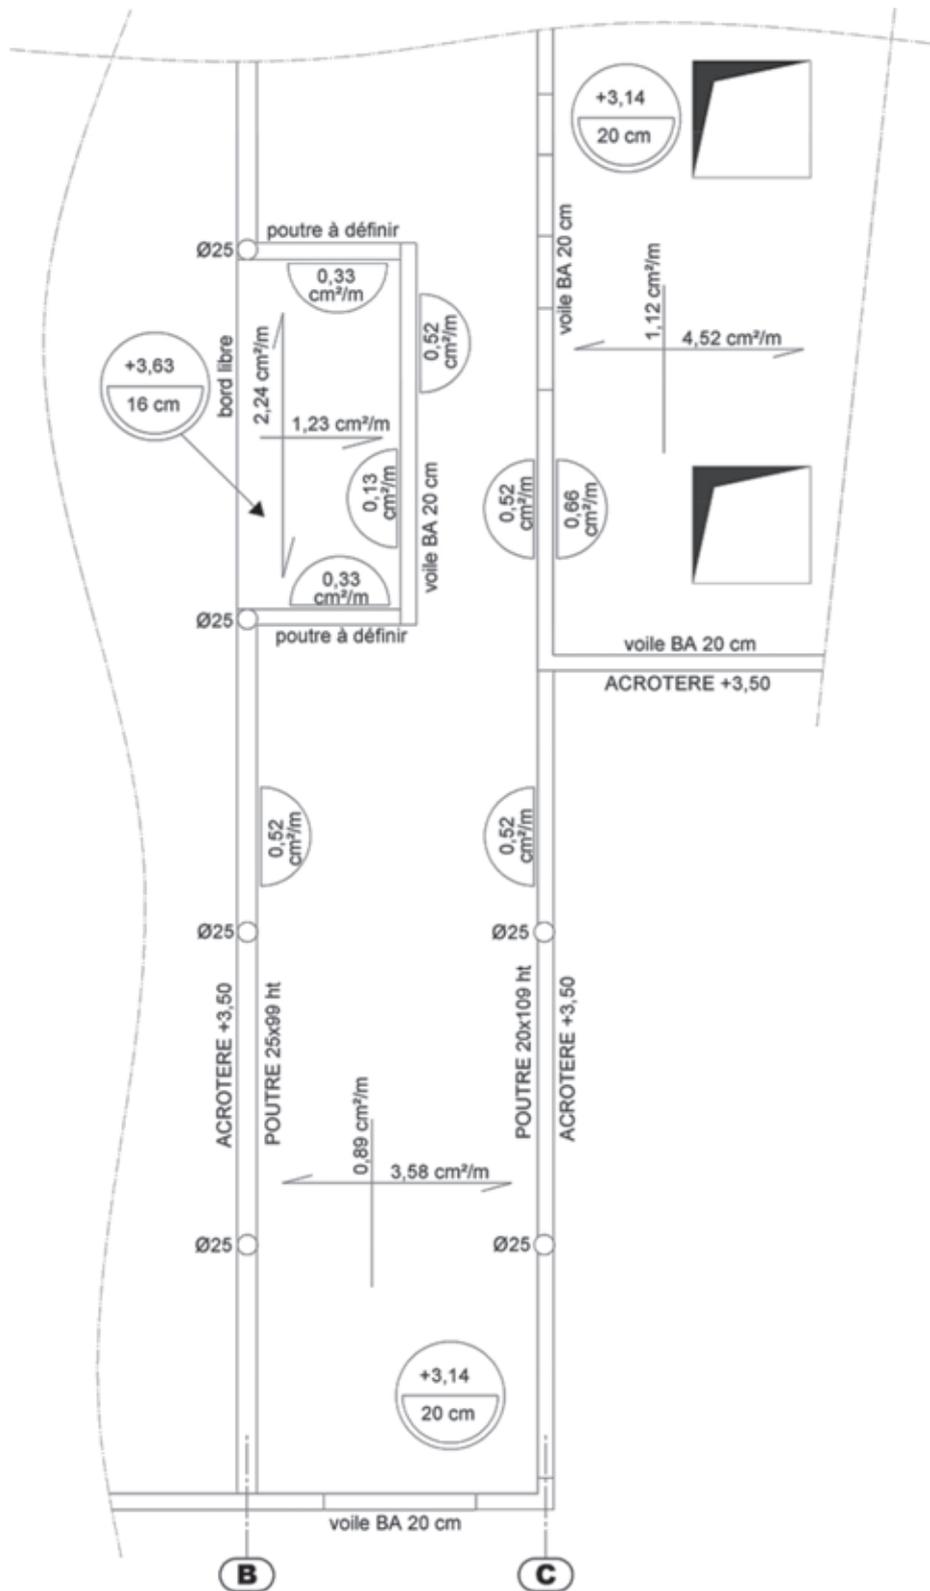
Sections des armatures des dalles (en cm^2/m)
